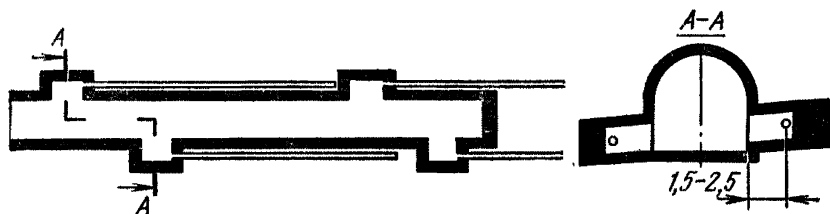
Схема расположения барьерных скважин при проведении выработок по угольному пласту
